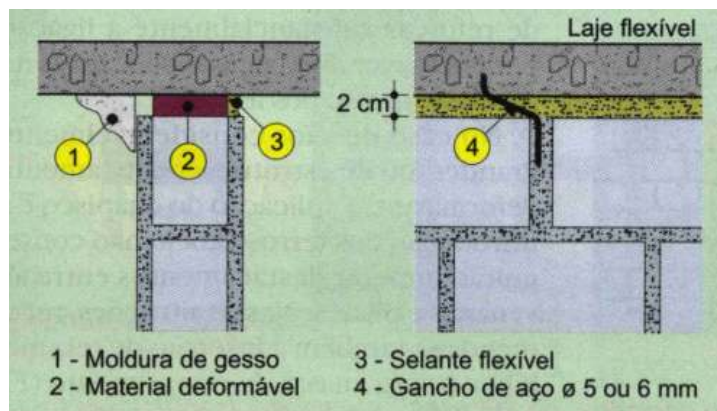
encontro de alvenaria com elementos estruturais, tais como vigas e lajes flexíveis (THOMAZ, 1998, p. 49)
